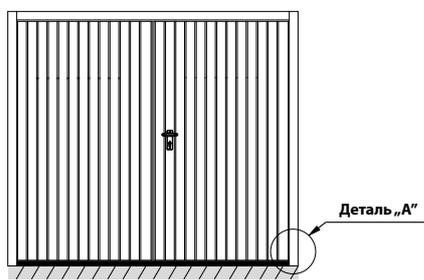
Двухстворчатые ворота, монтируемые на фундаменте - вид с наружной стороны.
